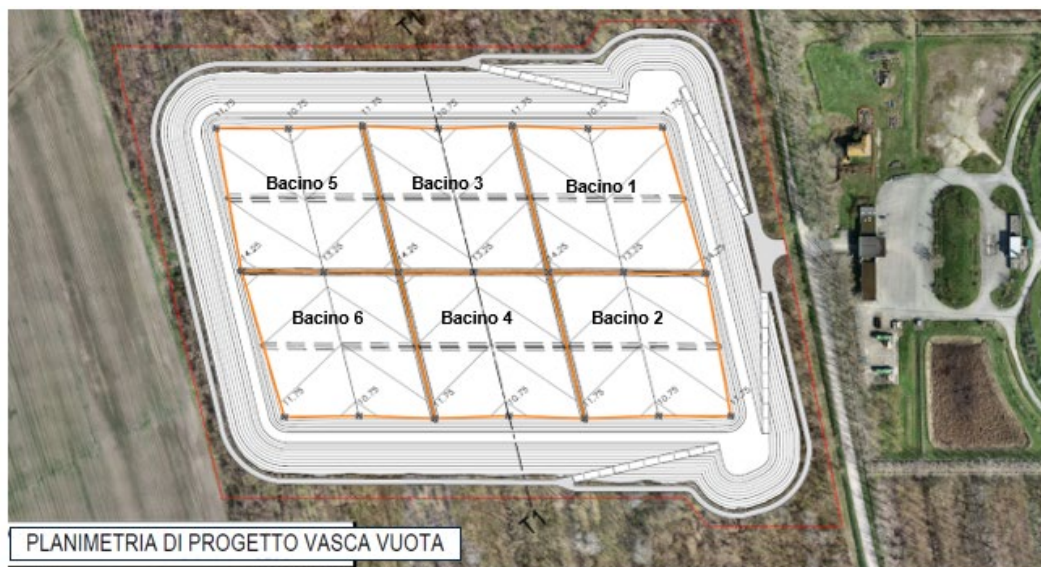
Planimetria generale dello stato di progetto, vasca vuota
